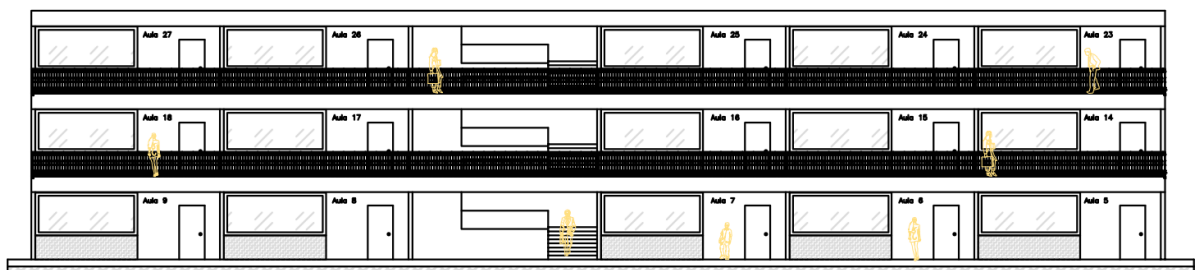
Fachada Posterior Edificio Escolar/Artes y talleres
